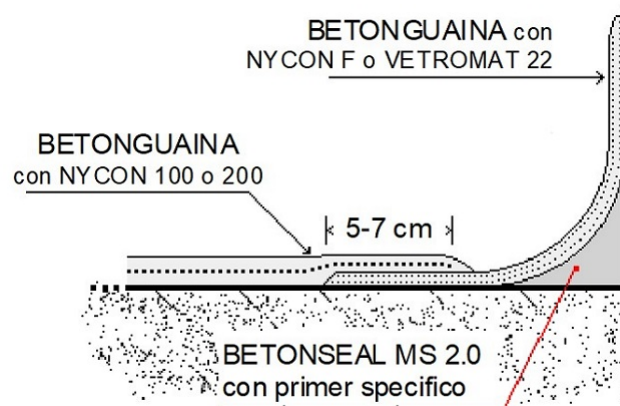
Impermeabilizzazione di risvolti verticali e superficie piana.
